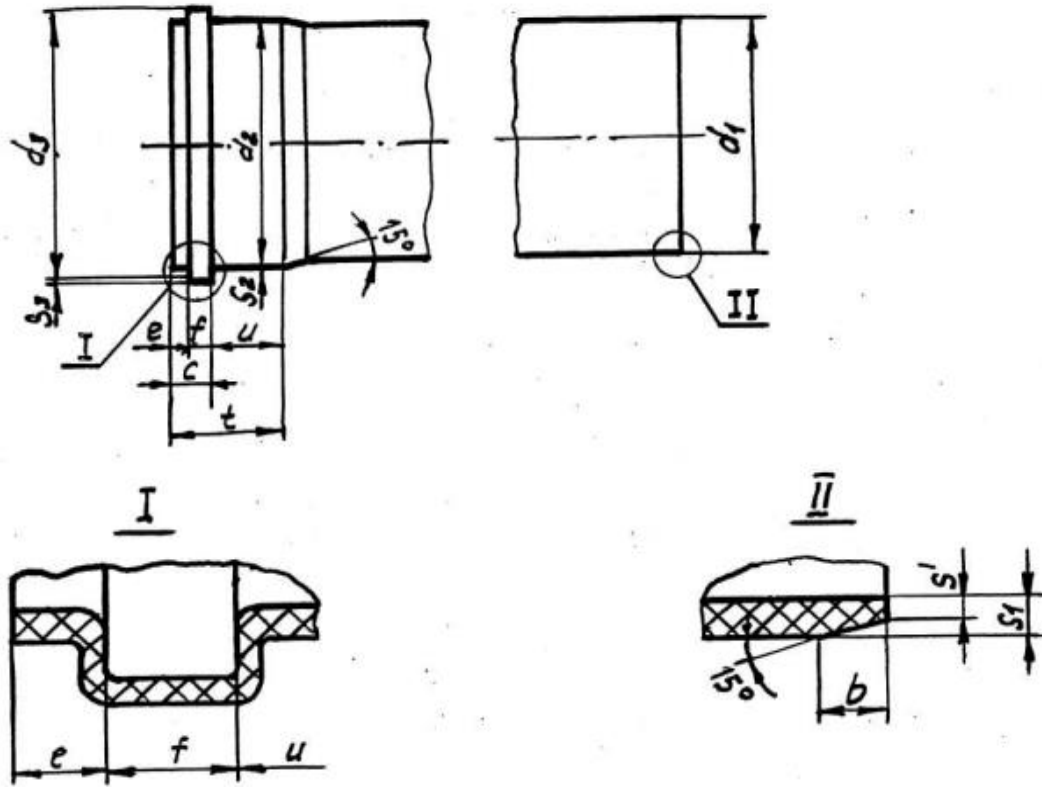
Конструкция и размеры раструбных и хвостовых частей труб.
